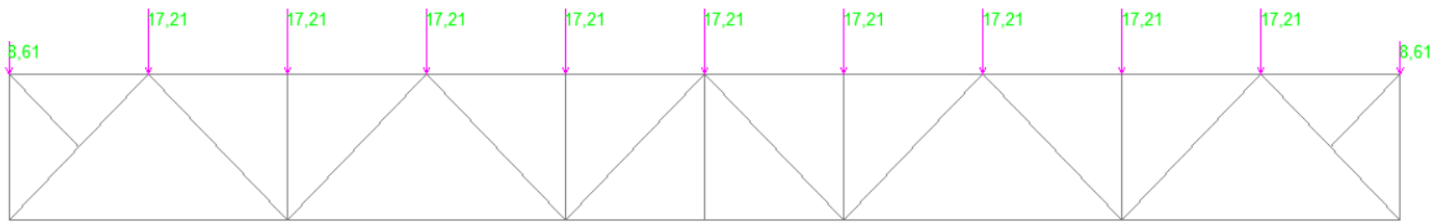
Схема загрузки постоянной нагрузкой
